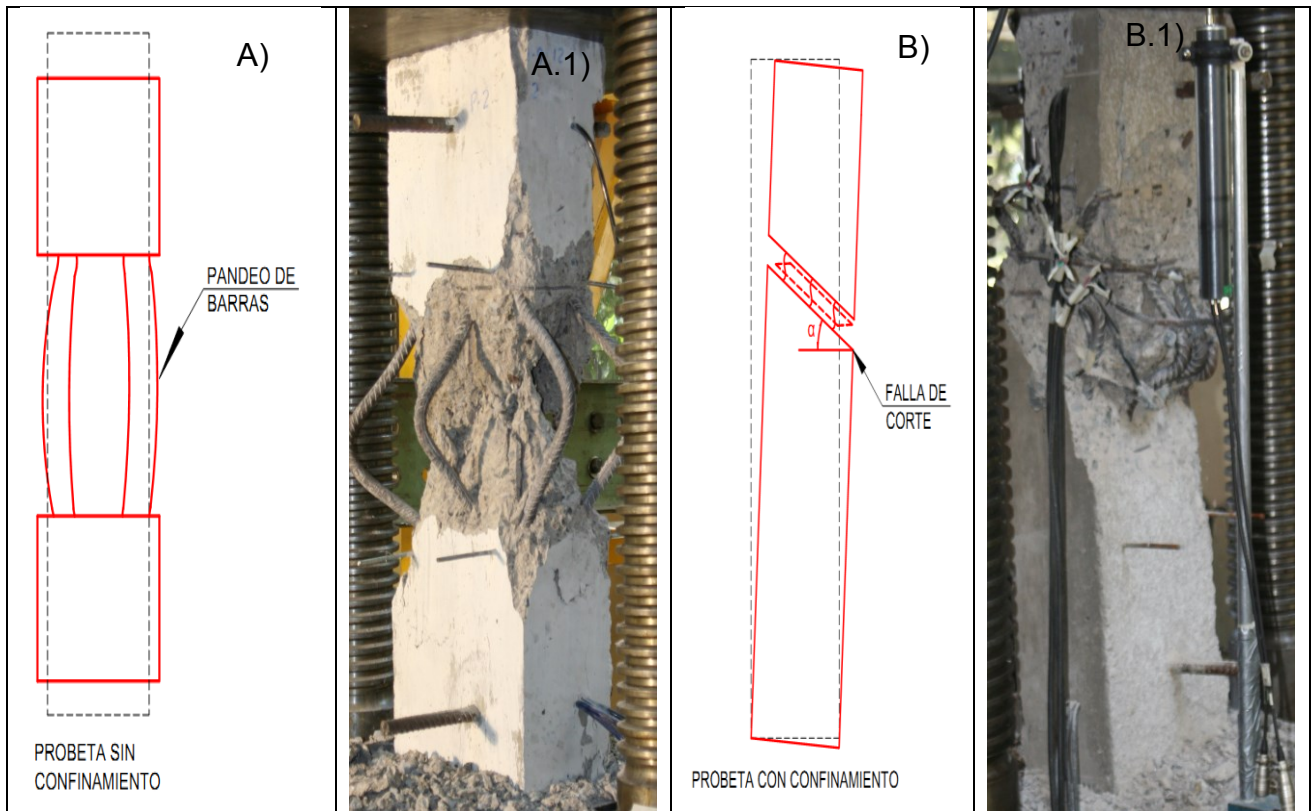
imagen A/A.1-Mecanismo de falla probetas sin confinamiento central. Imagen B/B-1Mecanismo de falla probetas con confinamiento central
